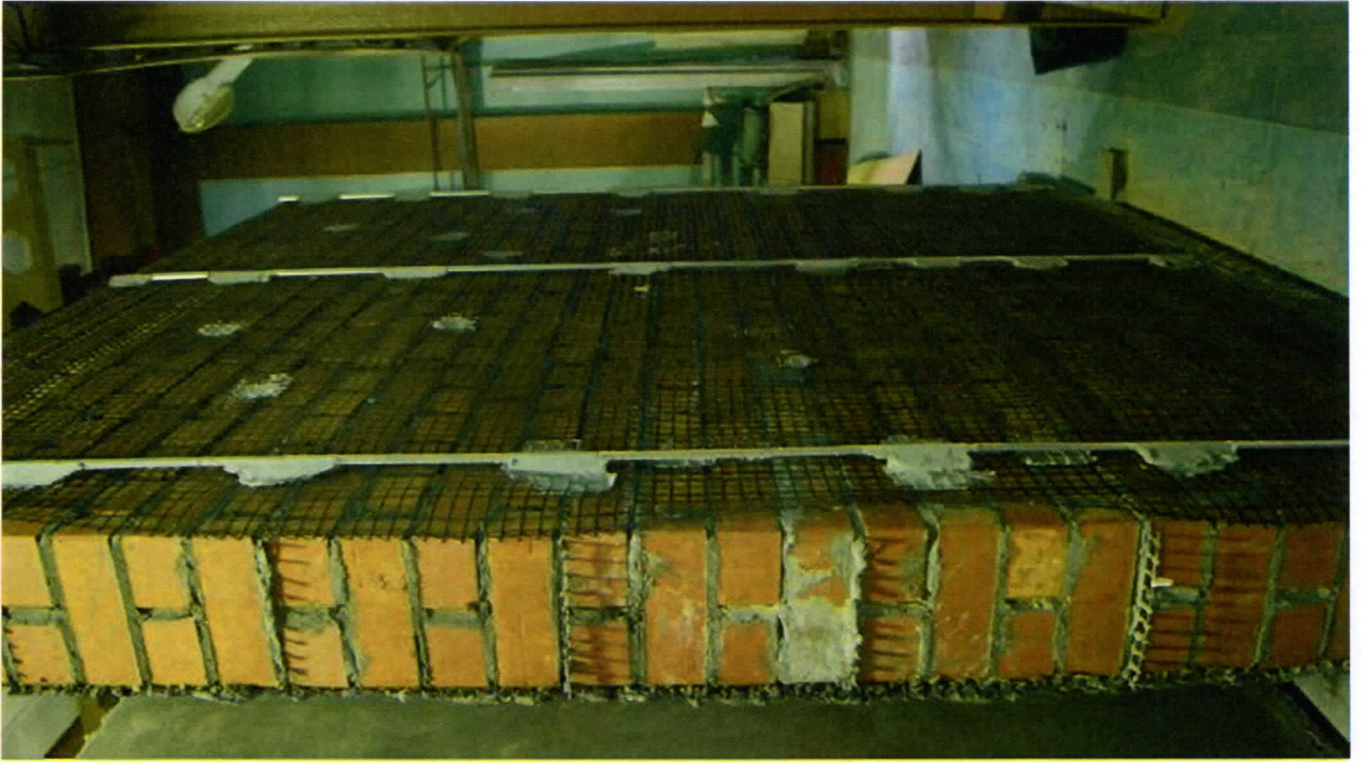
Раскладка вертикальной арматуры
